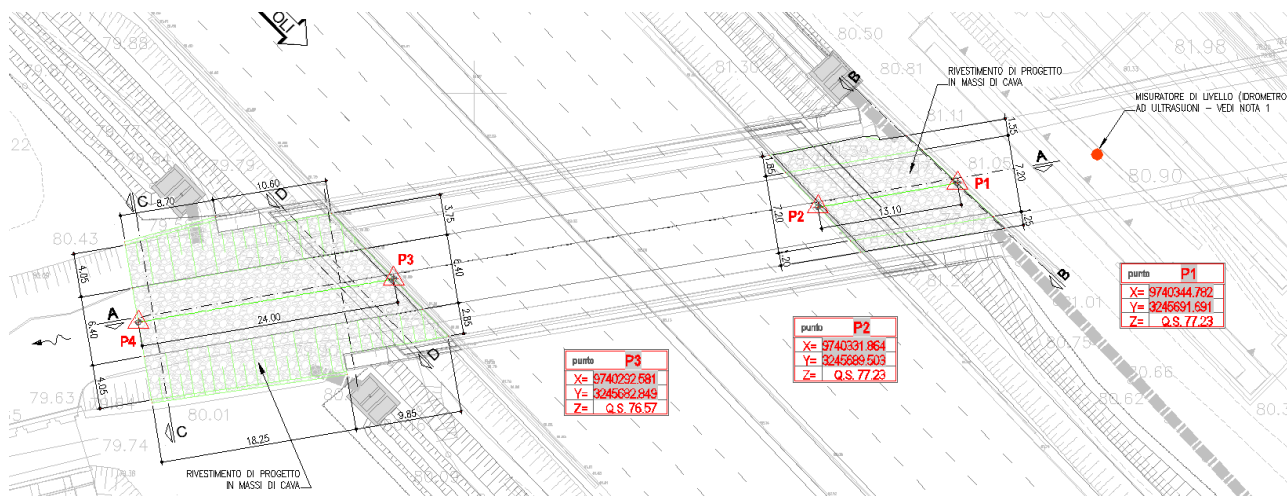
Planimetria della sistemazione spondale del Cavo Sillaro Salerano.
